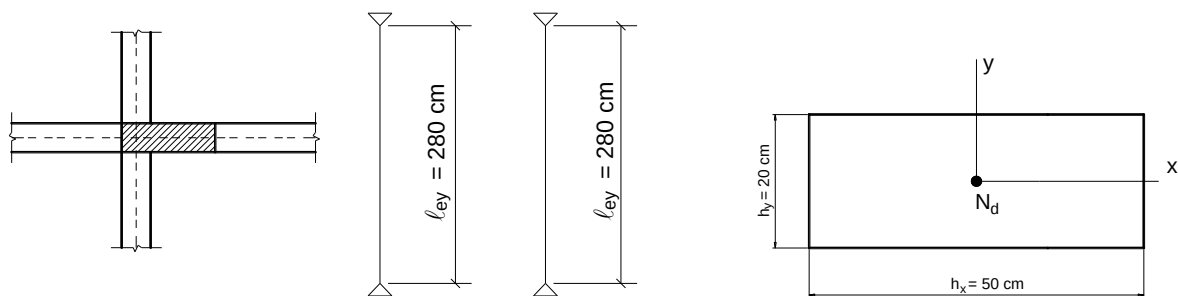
Posição do pilar em relação às vigas, vínculos na base e no topo nas direções x e y, dimensões da seção transversal e situação de projeto.
